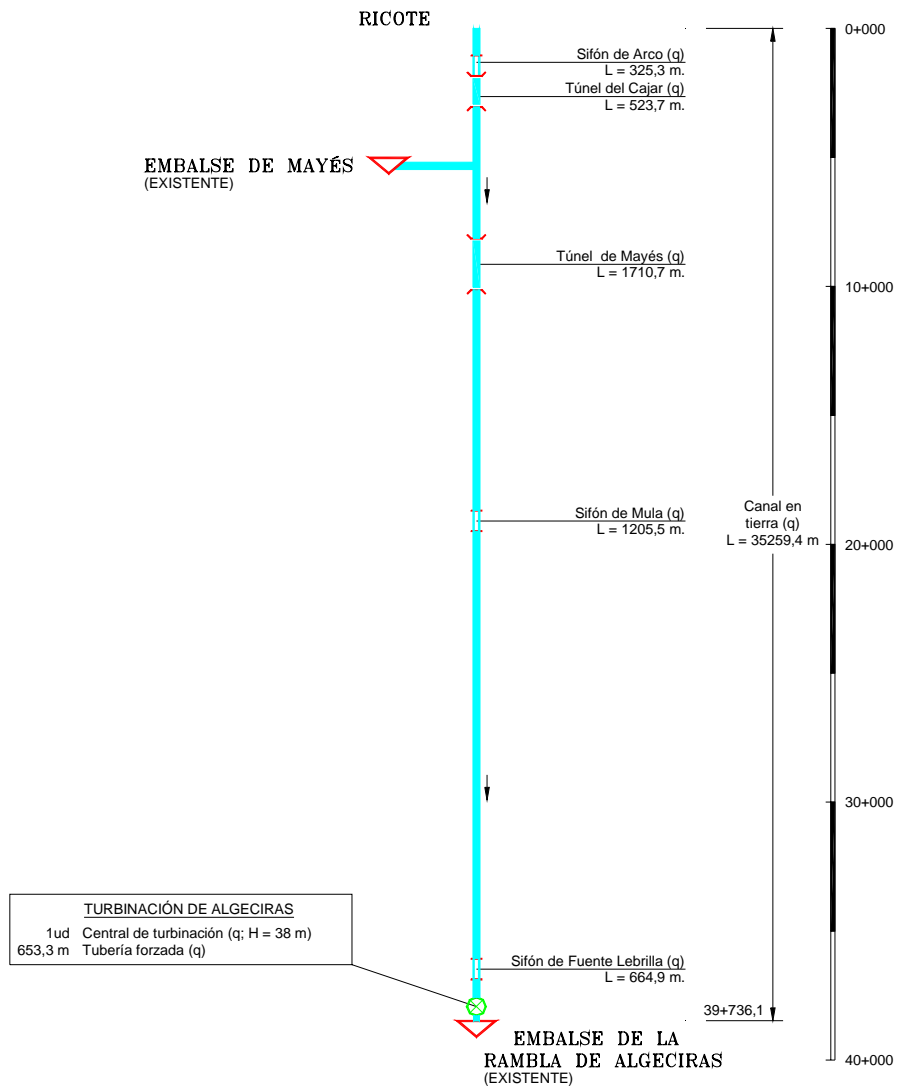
Conducción Ricote-Algeciras. Esquema en planta
